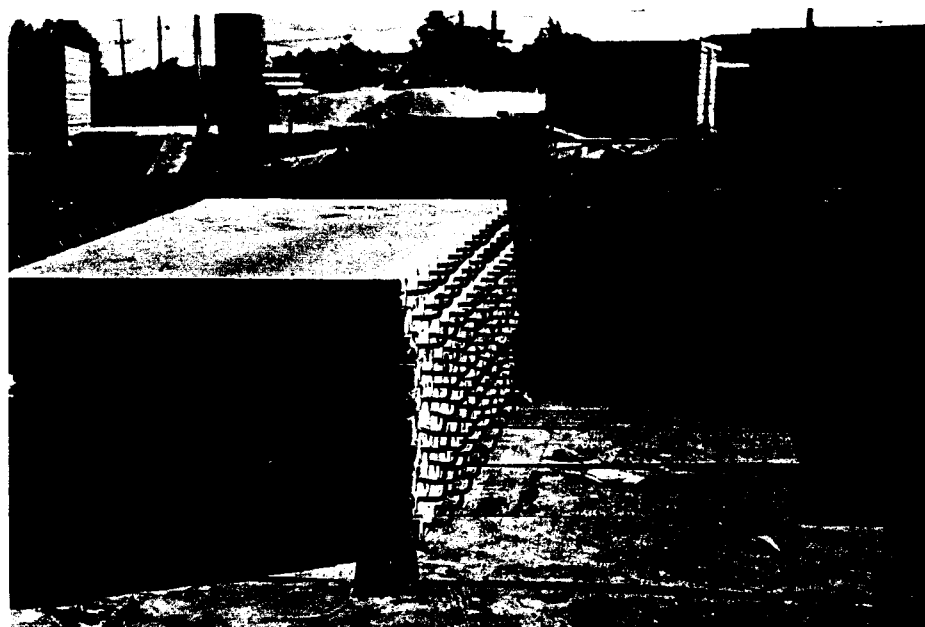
Placas pré-moldadas de concreto armado (4cm de espessura).
